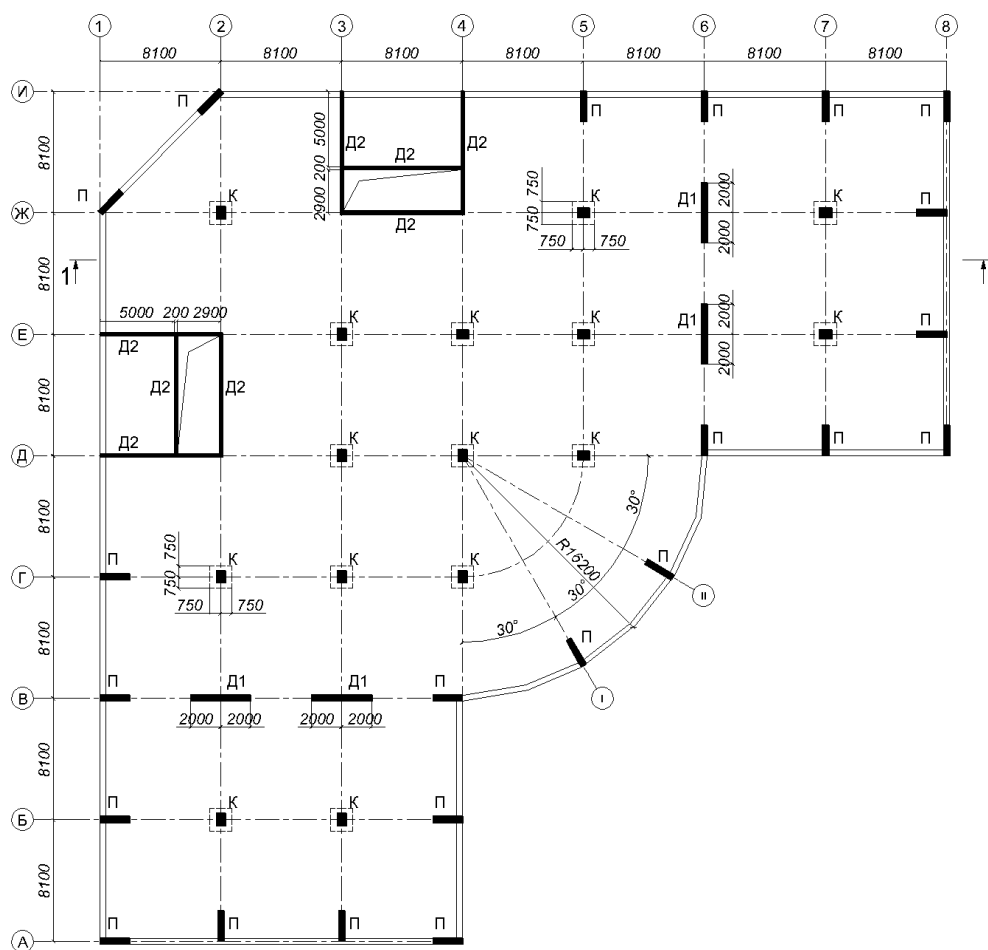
а. План типового этажа на отметках от -3.300 м до 9.900 м
